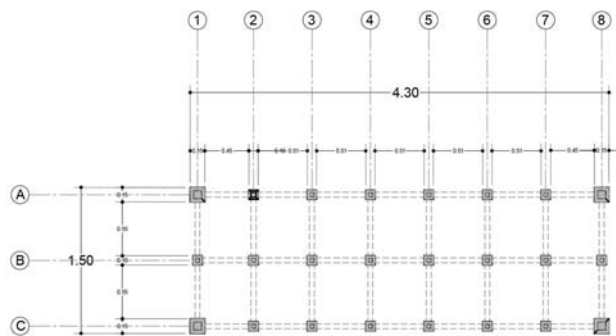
Nelly Hernandez (2018) Corte arquitectónico (plano).
